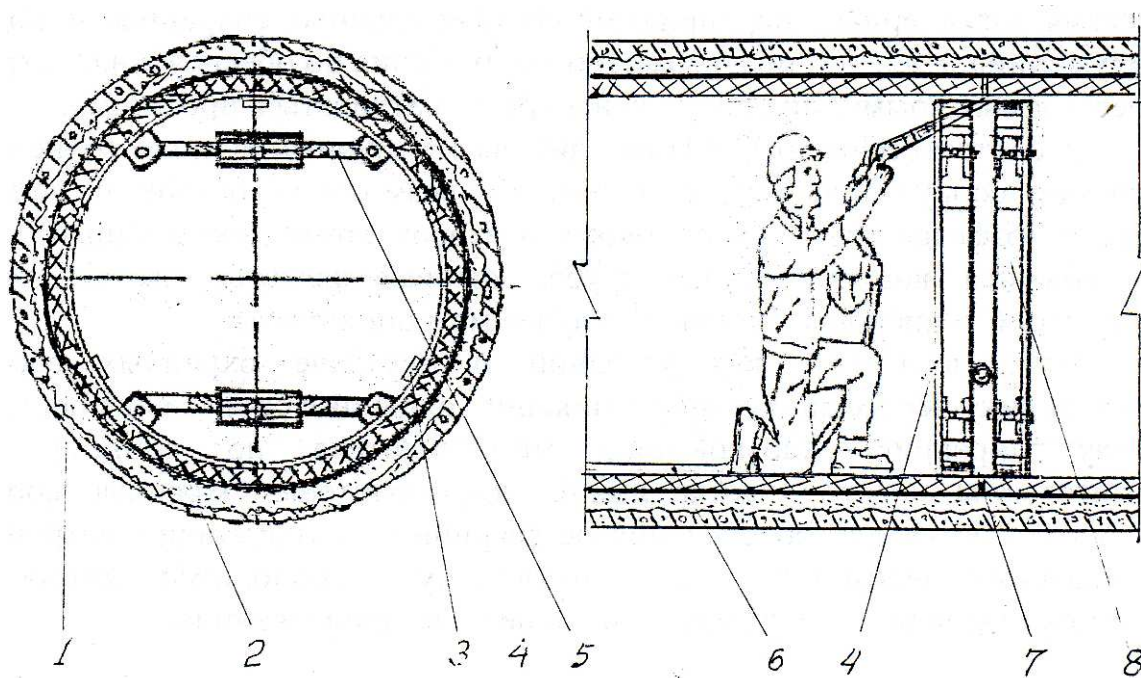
Способ заполнения уплотнителем межторцевого зазора и приспособление для осуществления способа: 1– обделка коллектора; 2 – труба-вкладыш; 3 – транспортный штуцер; 4 – транспортерная лента; 5 – фаркоп; 6 – резиновый шланг; 7 – торцы труб-вкладышей; 8 – металлическое прижимное кольцо.
